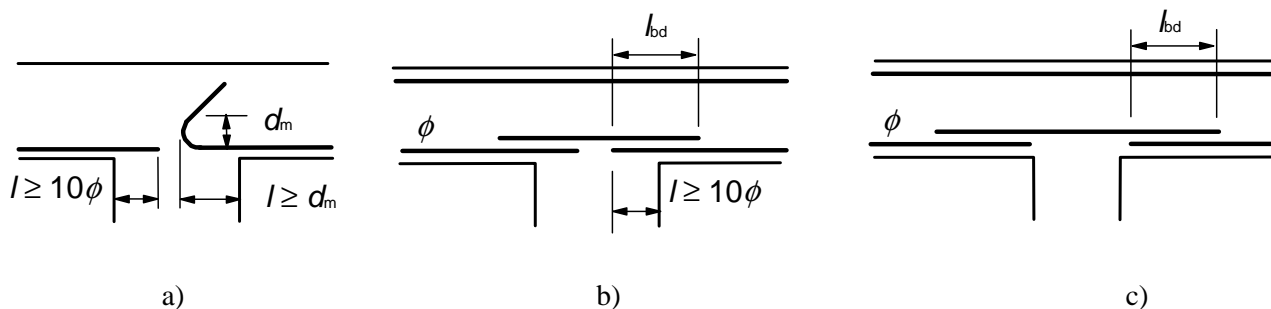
Amarração de armaduras inferiores em apoios extremos
